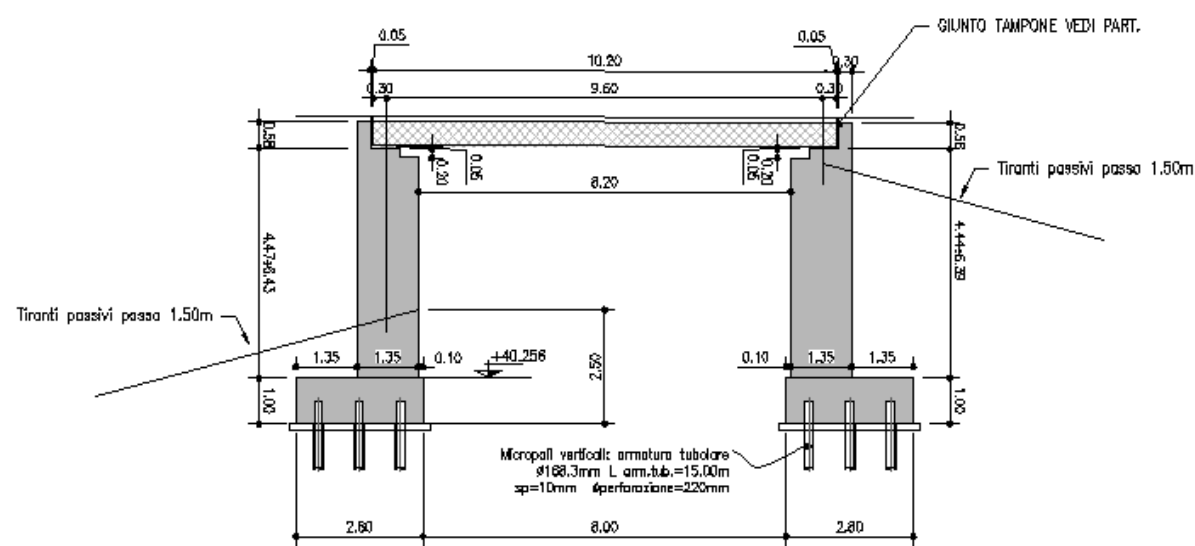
Sottovia via Campestre. Sezione longitudinale
